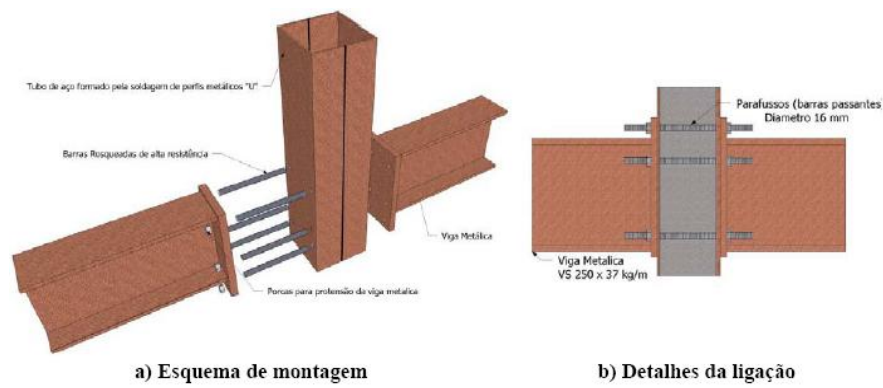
Detalhes da ligação viga-pilar misto. Farias (2008)
